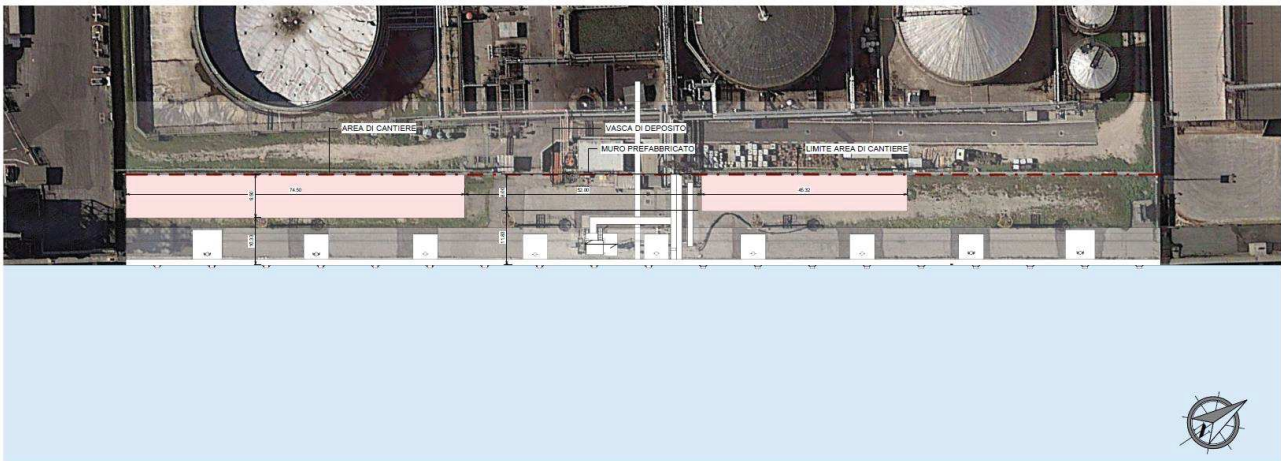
Planimetria con localizzazione delle aree operative e di stoccaggio.
